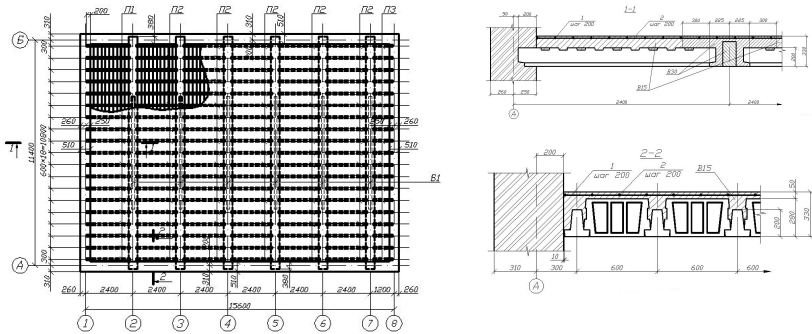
Конструктивное решение сборно-монолитного перекрытия
